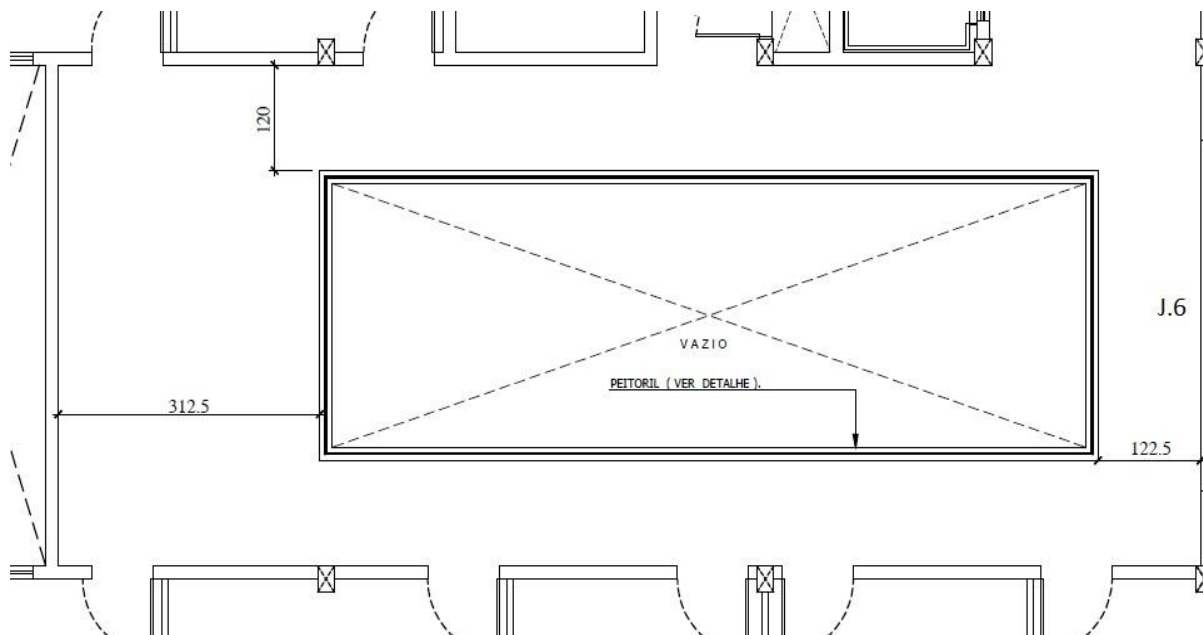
Circulação Primeiro, Segundo e Terceiro Pavimento
